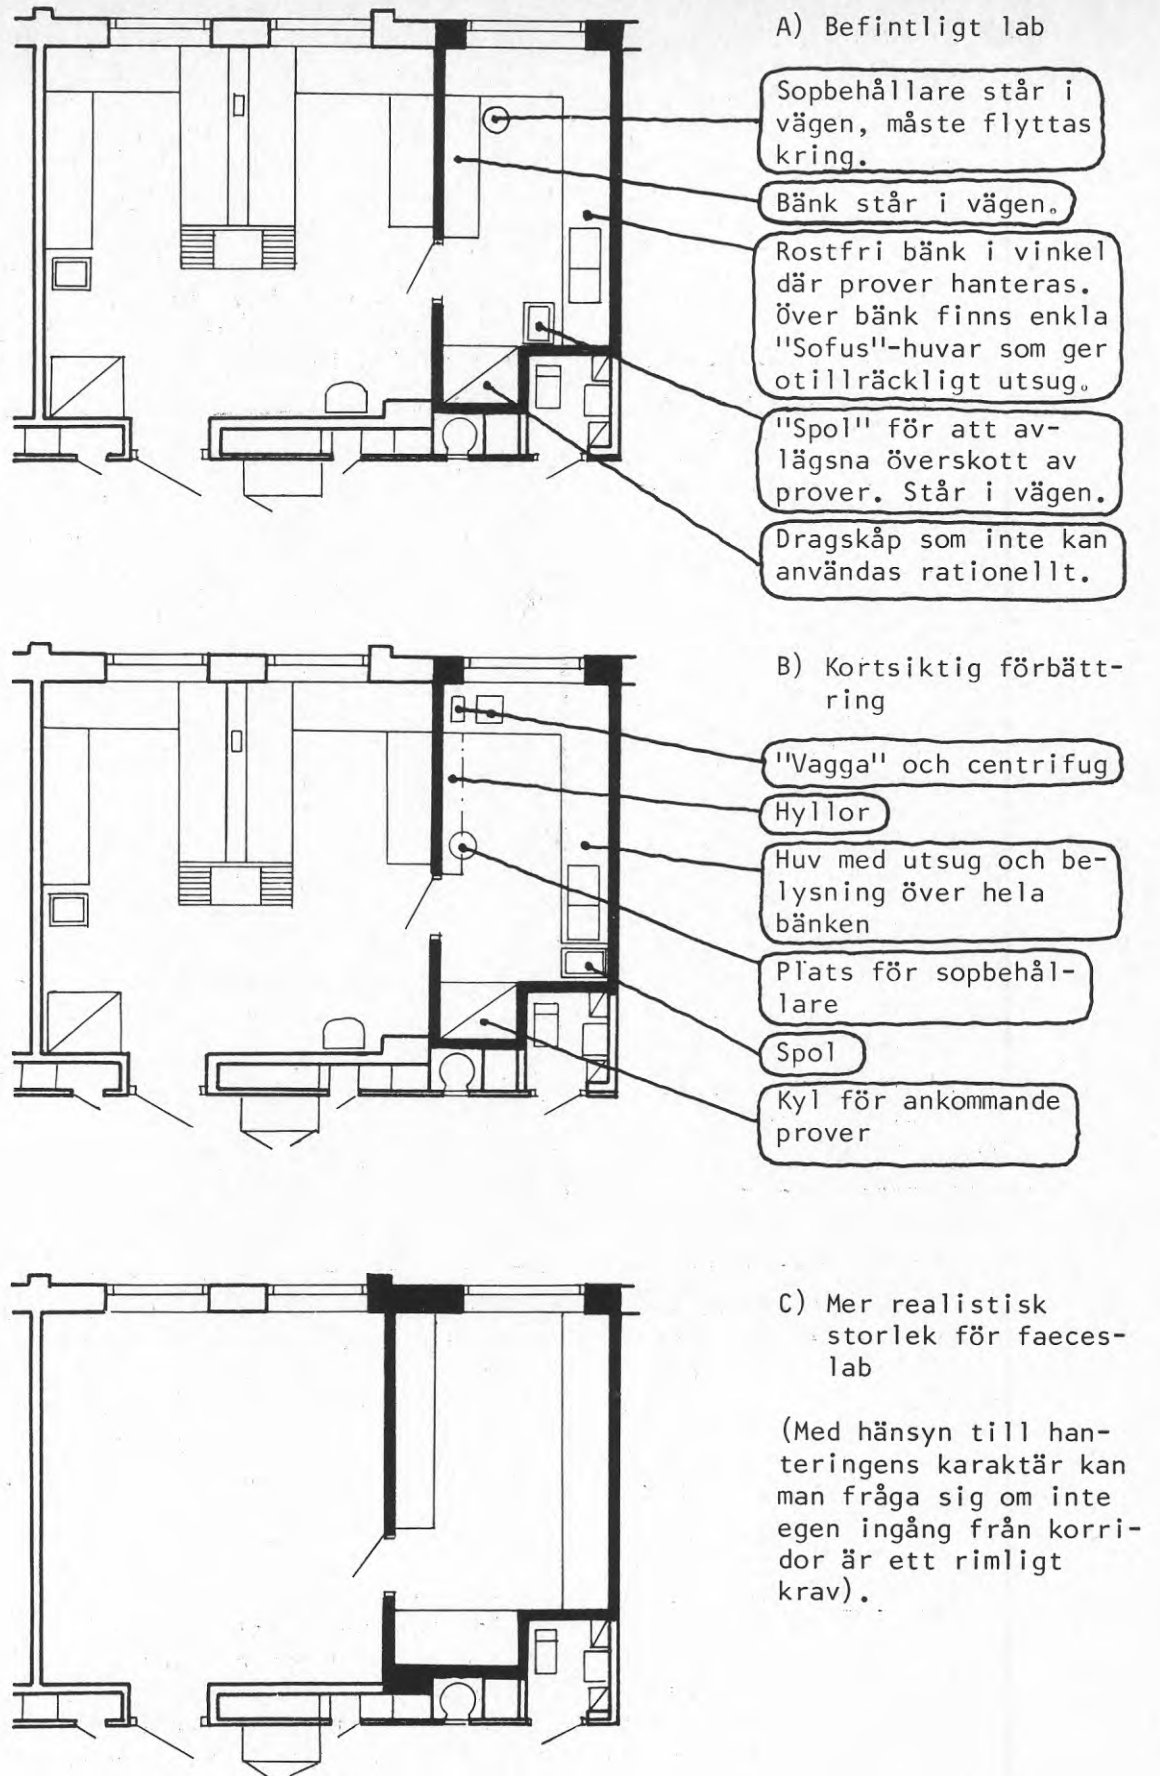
Faeceslab, plan skala 1:100.
